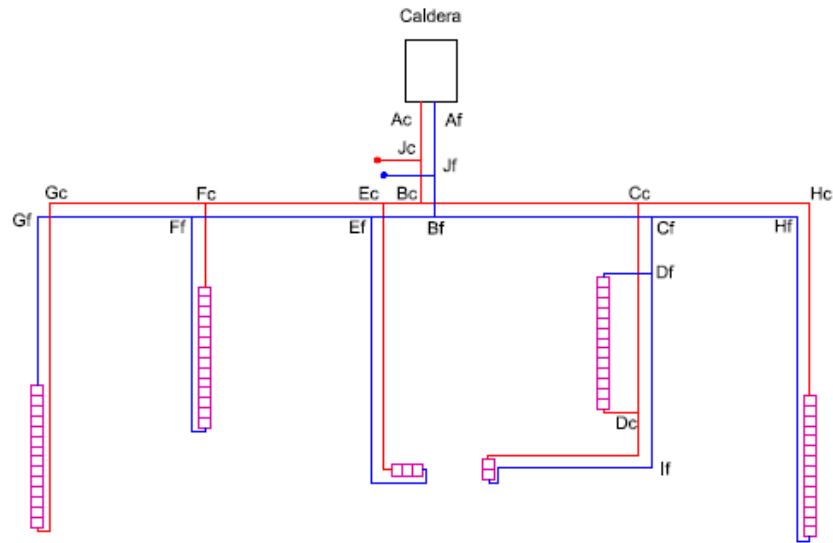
Esquema de la xarxa de canonades de l'instal·lació de la planta baixa.
